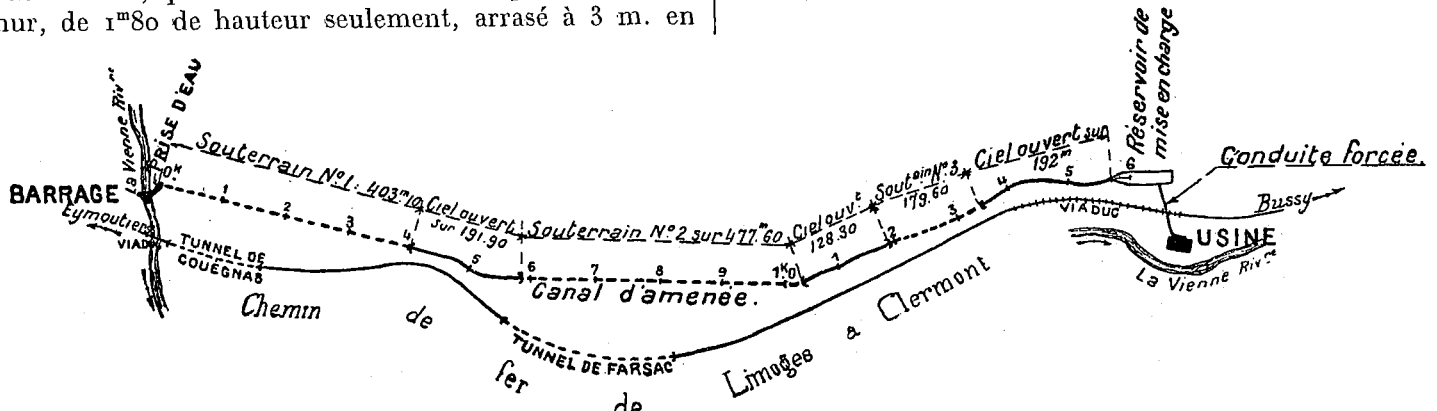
PLAN GÉNÉRAL DE L'AMÉNAGEMENT HYDRAULIQUE DE LA CHUTE D'EYMOUTIERS
